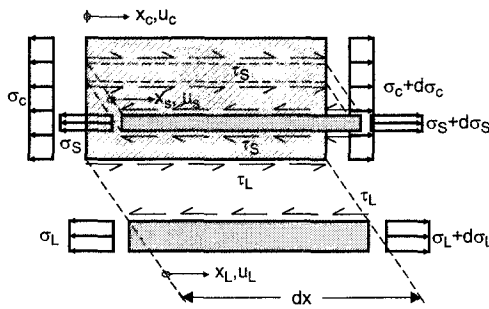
Differenzielles Element eines klebarmierten Stahlbetonzugstabes
